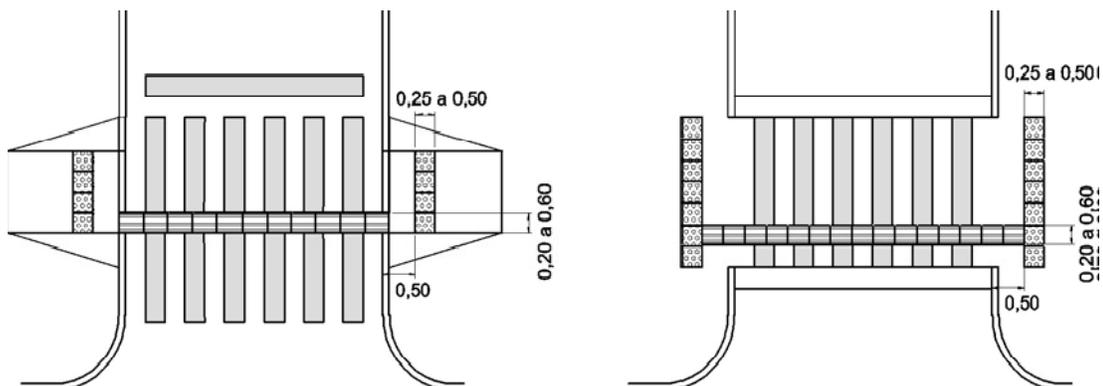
Rebaixamento de Calçada e Faixa Elevada com Sinalização Tátil
